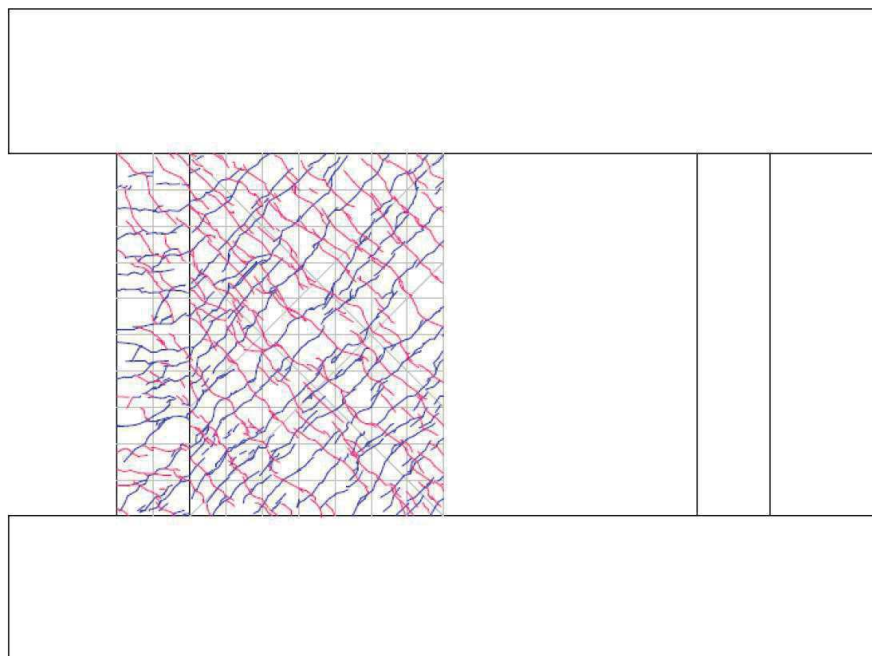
試験体 S-13-DIV 事前加力終了時 (6/1000rad.) ひび割れ図
